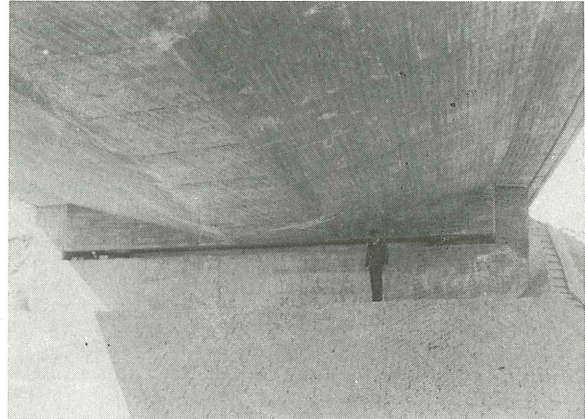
Vista del esquema de apoyo en estribos del puente 3.
